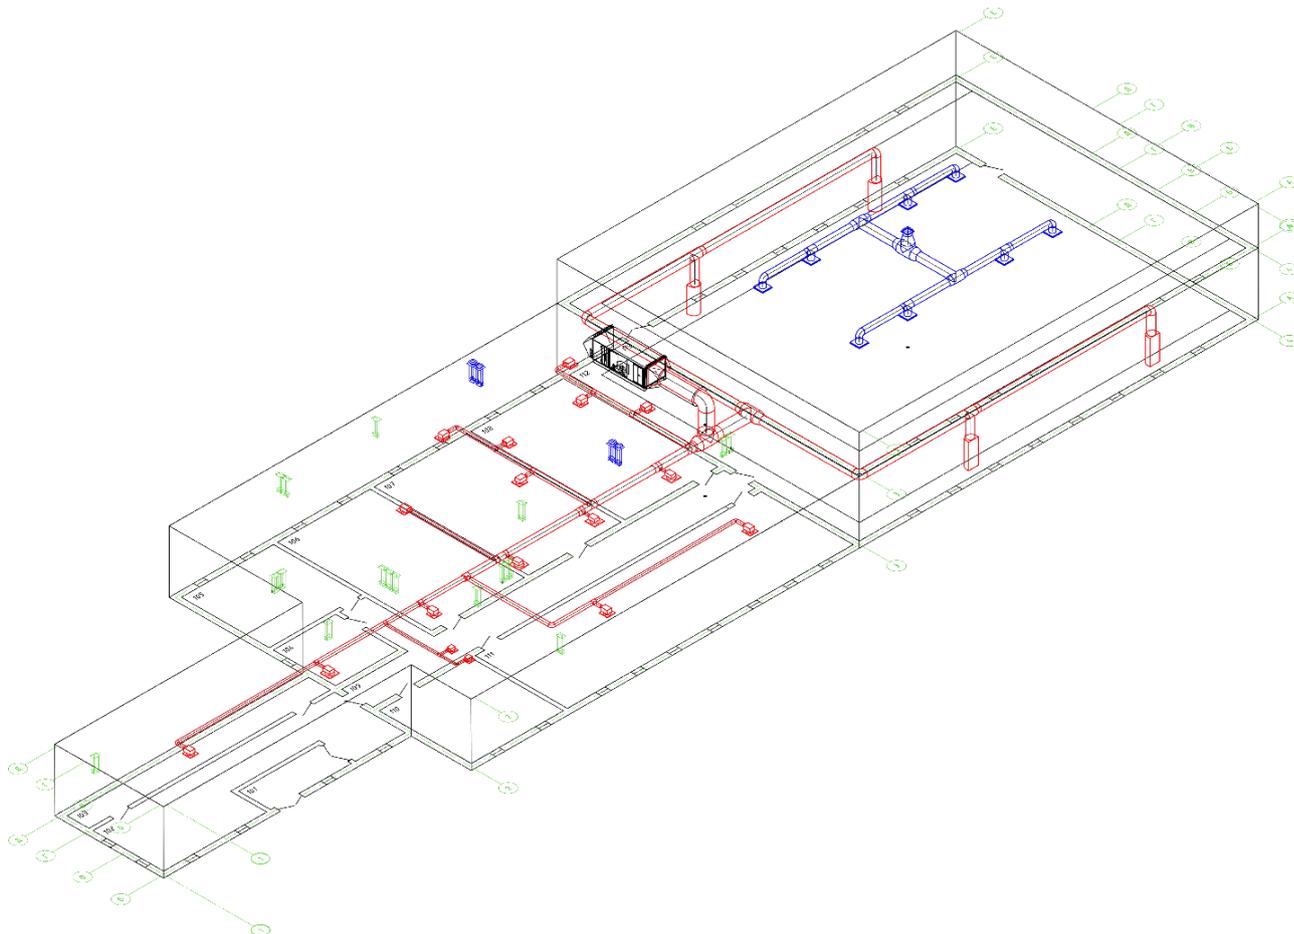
3D план системы вентиляции спорткомплекса.
